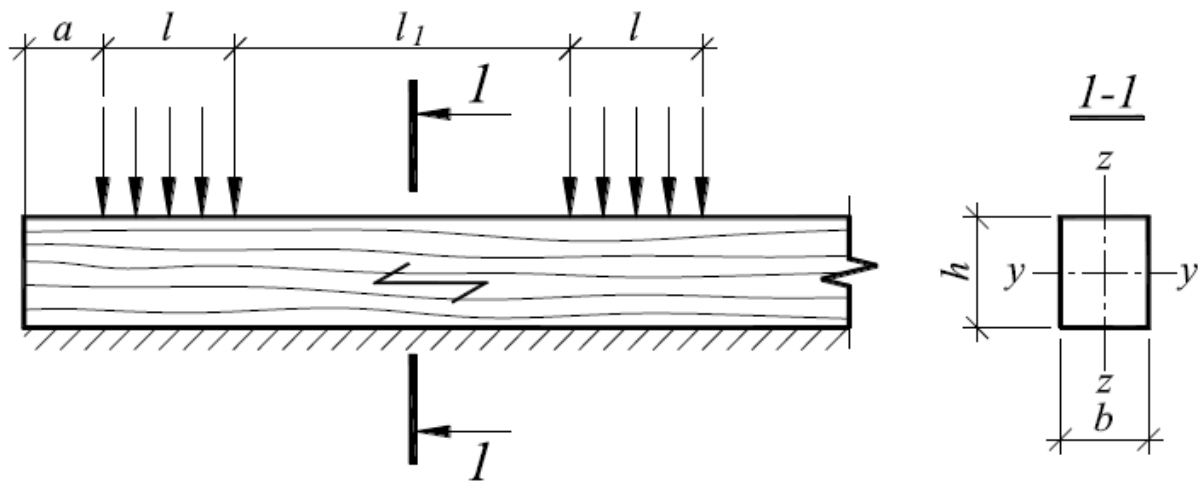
Схема опирания элемента на сплошную опору
